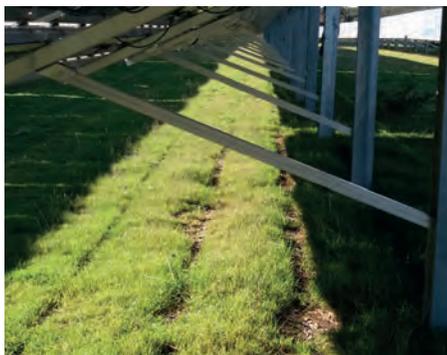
Table fixe sur mono-pieu battu (© Idele)
